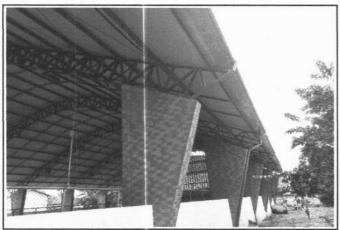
PINTURA EM ESTRUTURA METÁLICA
